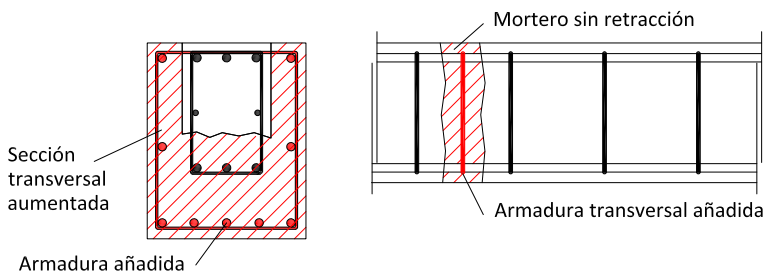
Refuerzo mediante actuación directa en la sección existente de hormigón armado: (izquierda) incremento sección transversal, (derecha) adición de estribos.
